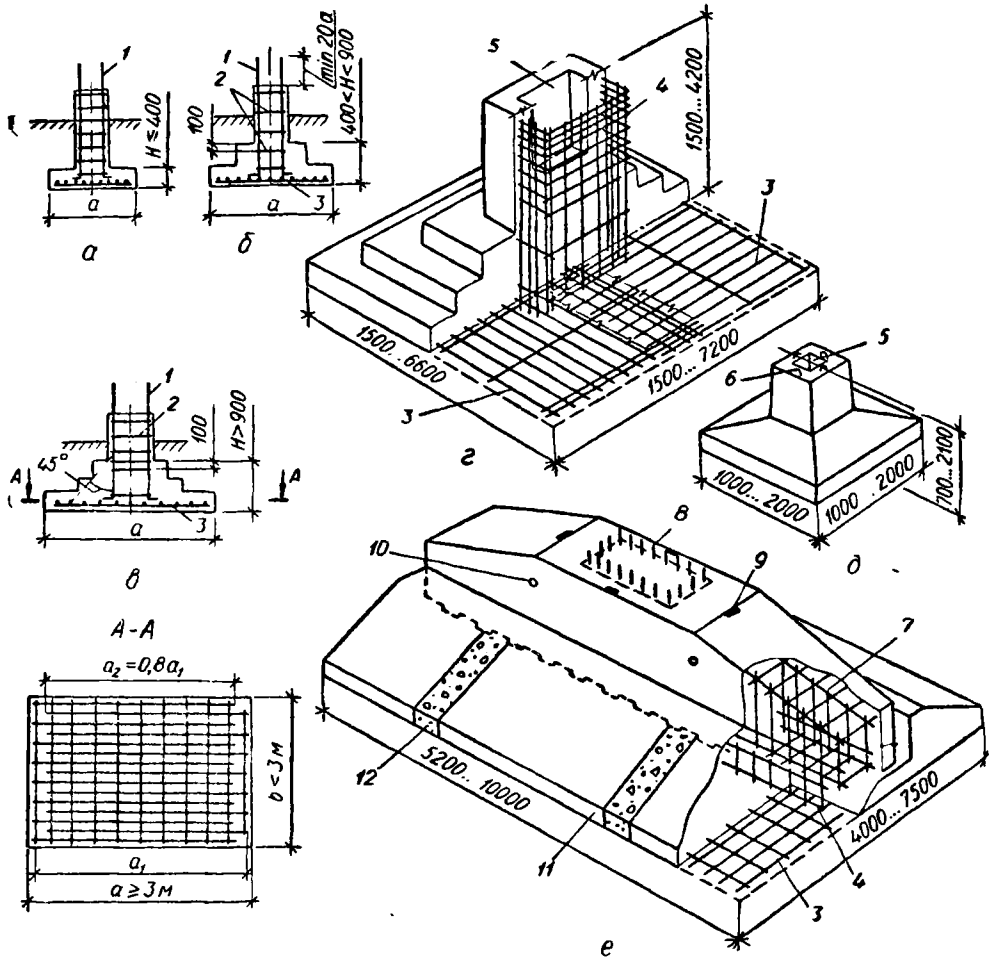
Залізобетонні фундаменти під окремі колони:
